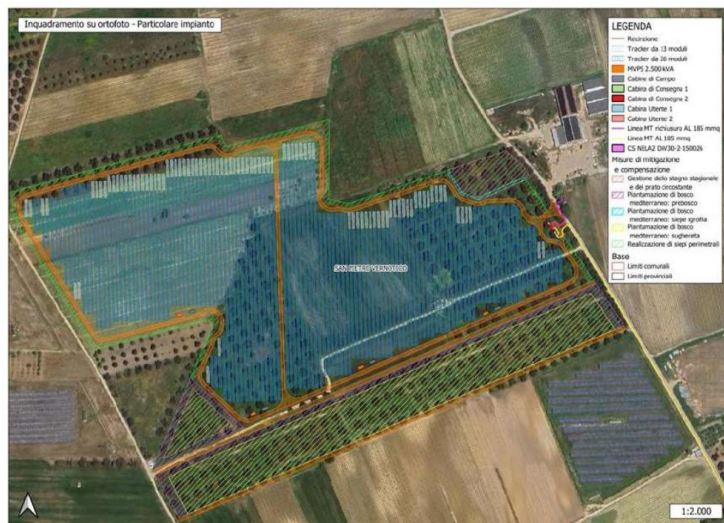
Particolare Layout dell'impianto su ortofoto - elaborato di progetto
